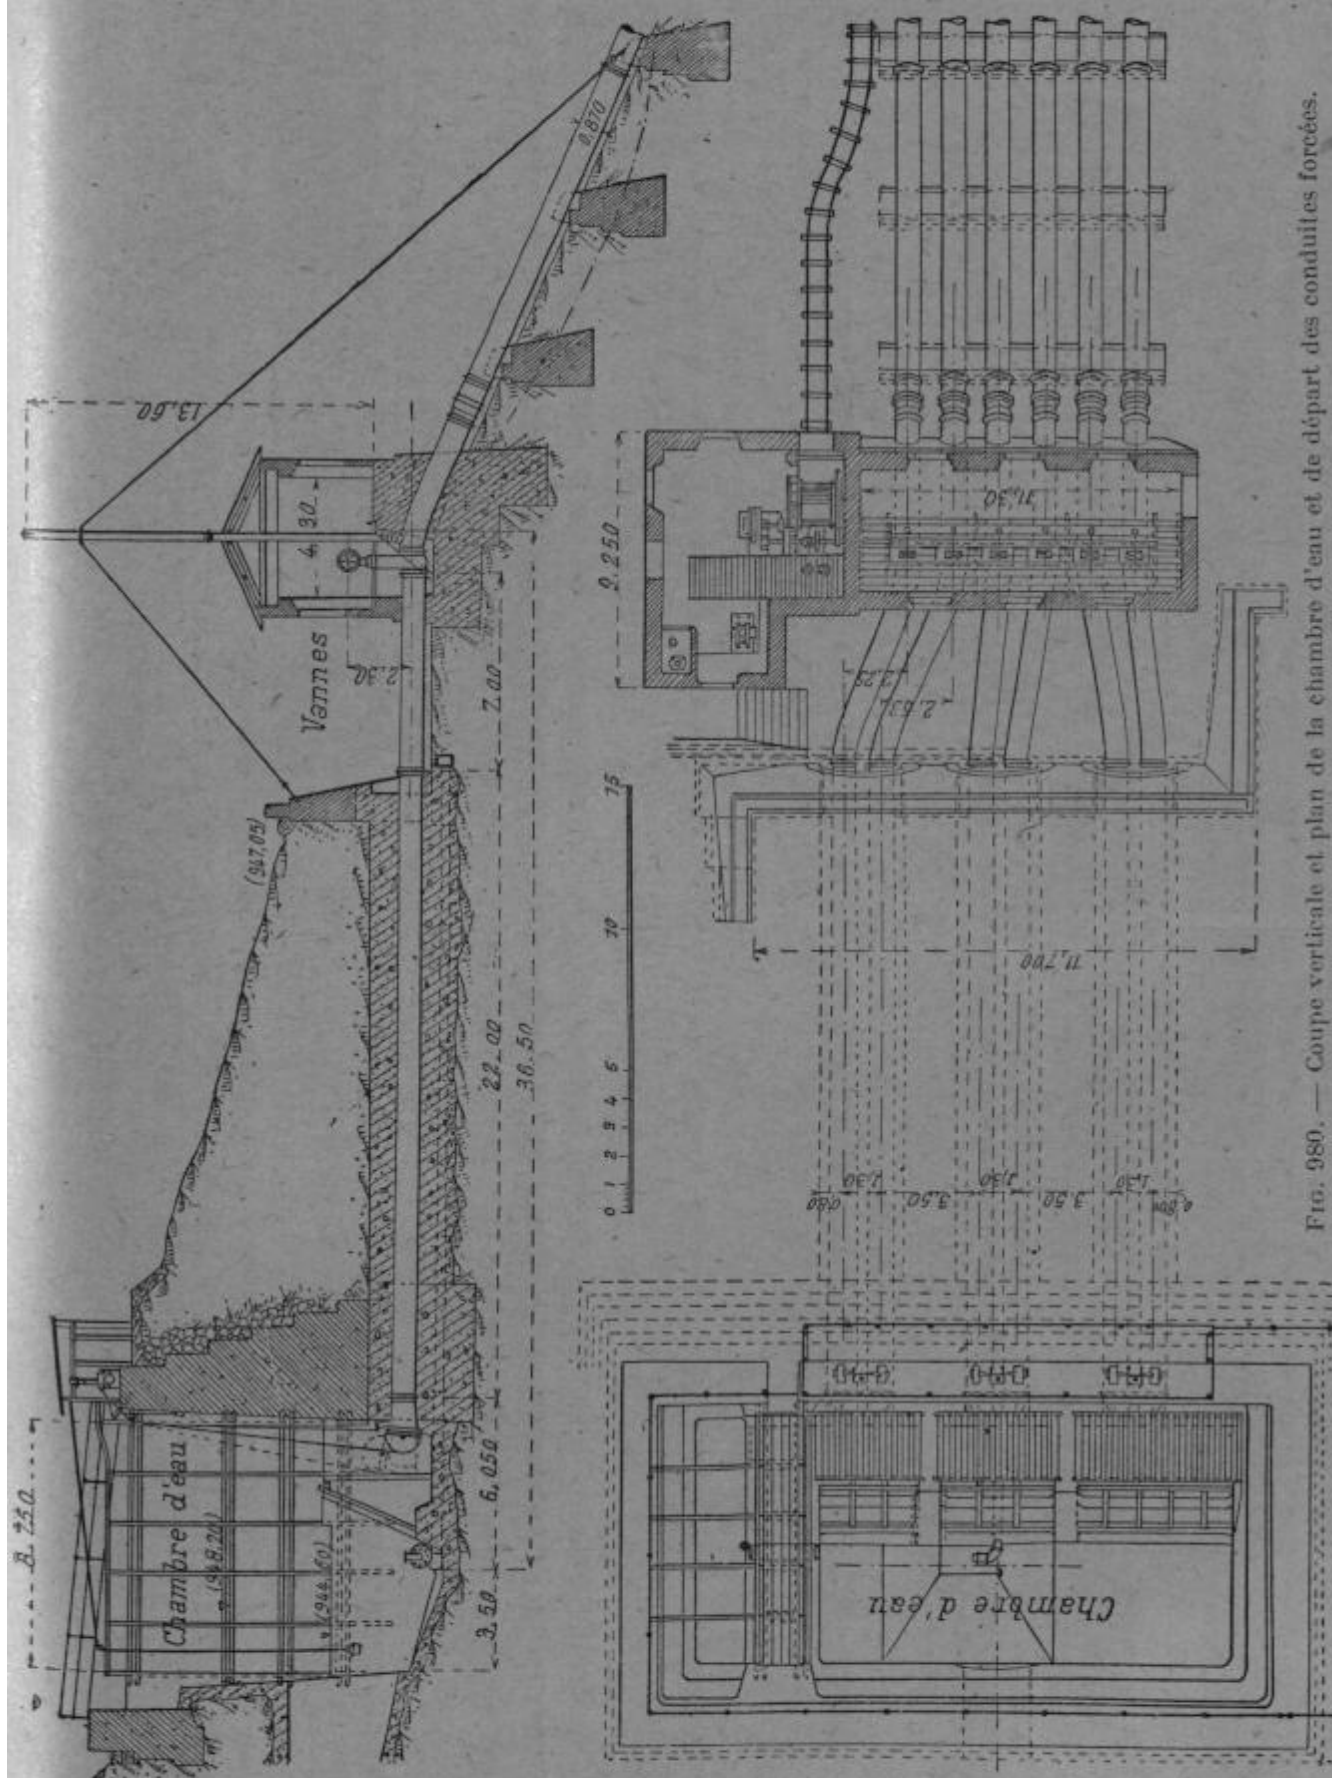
Coupe verticale et plan de la chambre d'eau et de départ des conduites forcées.
